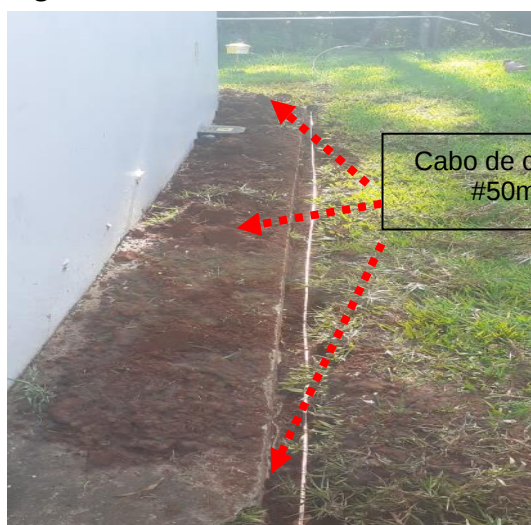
e 196: Malha de aterramento construída na área de central de Resíduos.
